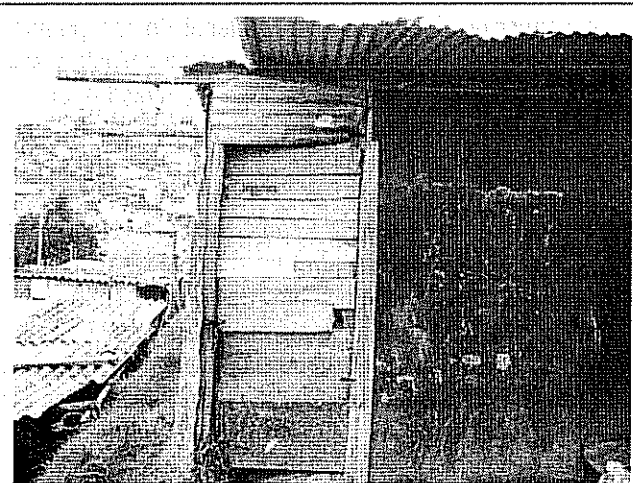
Vivienda 2 ubicada en la parte alta del talud de corte y relleno. construcción en material de recuperación
